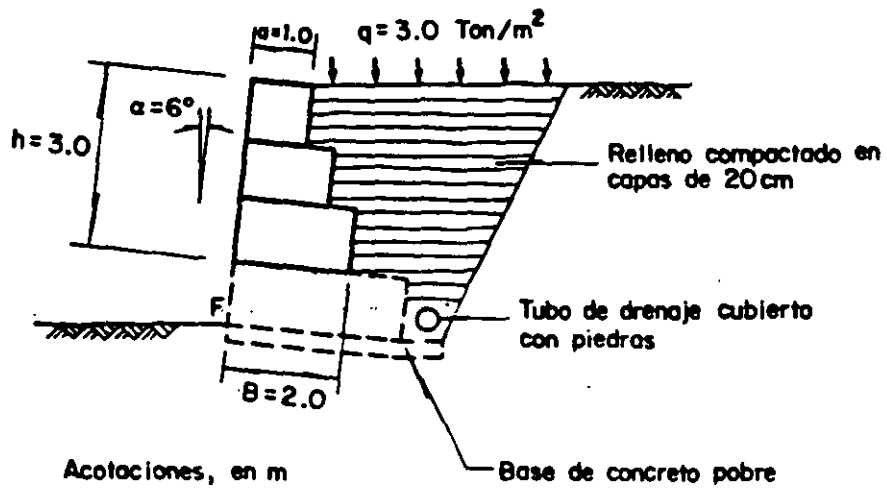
Sección transversal intermedia del muro de sostenimiento
